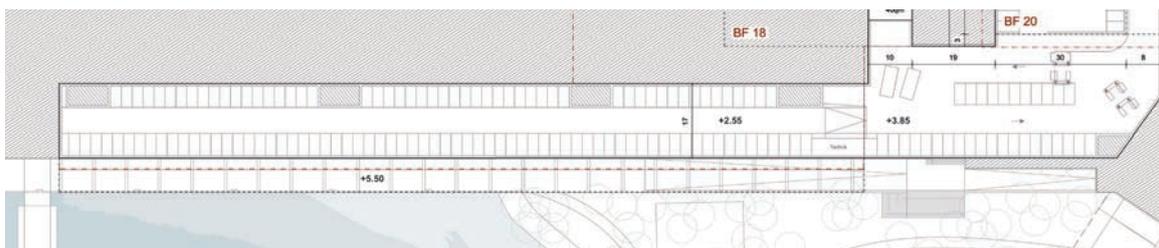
Das untere Warftgeschoss im Grundriss
